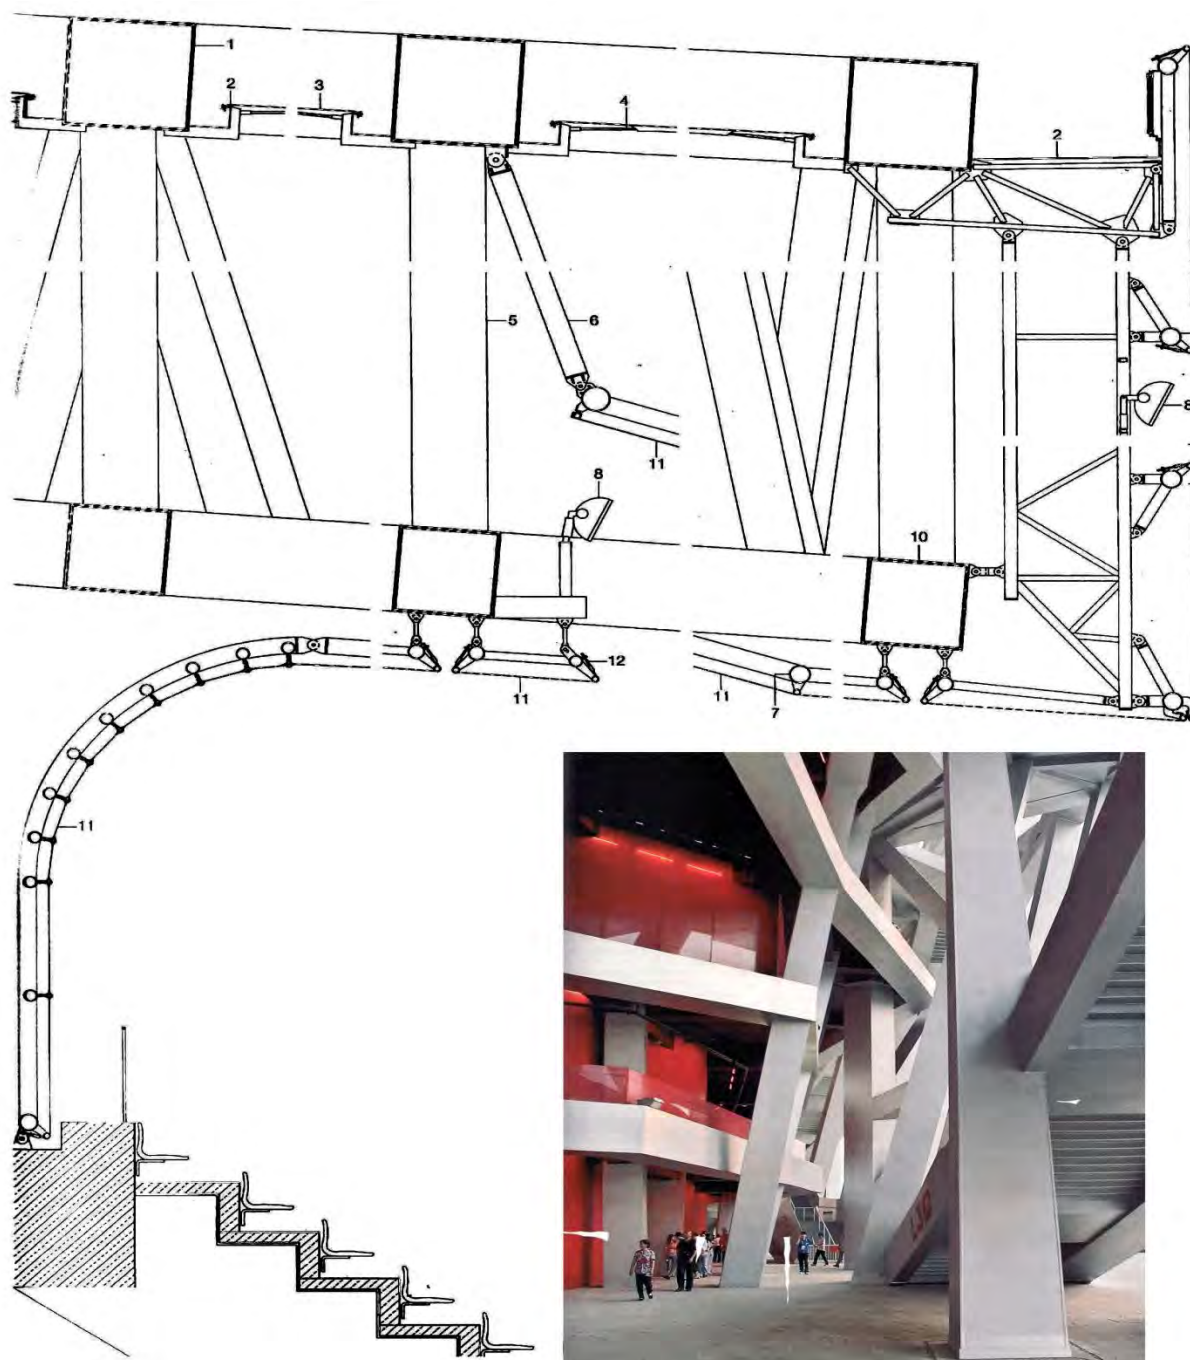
Разрез верхнего отдела крыши и интерьера: 1 – верхний пояс фермы структуры покрытия, 1000/1000/20 мм сталь SHS; 2 – дренажные желоба, стальной лист; 3 – защита от осадков, 250 ETFE мембрана; 4 – стяжка для мембраны ETFE, $d = 10$ мм стальной кабель; 5 – диагональные распорки в структуре кровли, 600/600/20 мм сталь SHS; 6 – подвески для мембраны тефлоновой фермы, $d = 180$ мм стальная труба; 7 – рама для тефлоновой мембраны, $d = 160$ мм стальная труба; 8 – прожектор стадиона; 9 – край крыши, просеивающий свет и вертикальная защита от осадков: визуальное просеивание, погодная проверка, тефлоновое покрытие из стекловолокна, устойчивую к попаданию воды; 10 – нижний пояс фермы, 800/800/20 мм сталь SHS; 11 – оптические экраны и акустическая мембранная ткань из стекловолокна, покрытая тефлоном; 12 – растяжка для мембраны из тефлона, крепится к стальной пластине с помощью болта $d = 89$ мм M10
